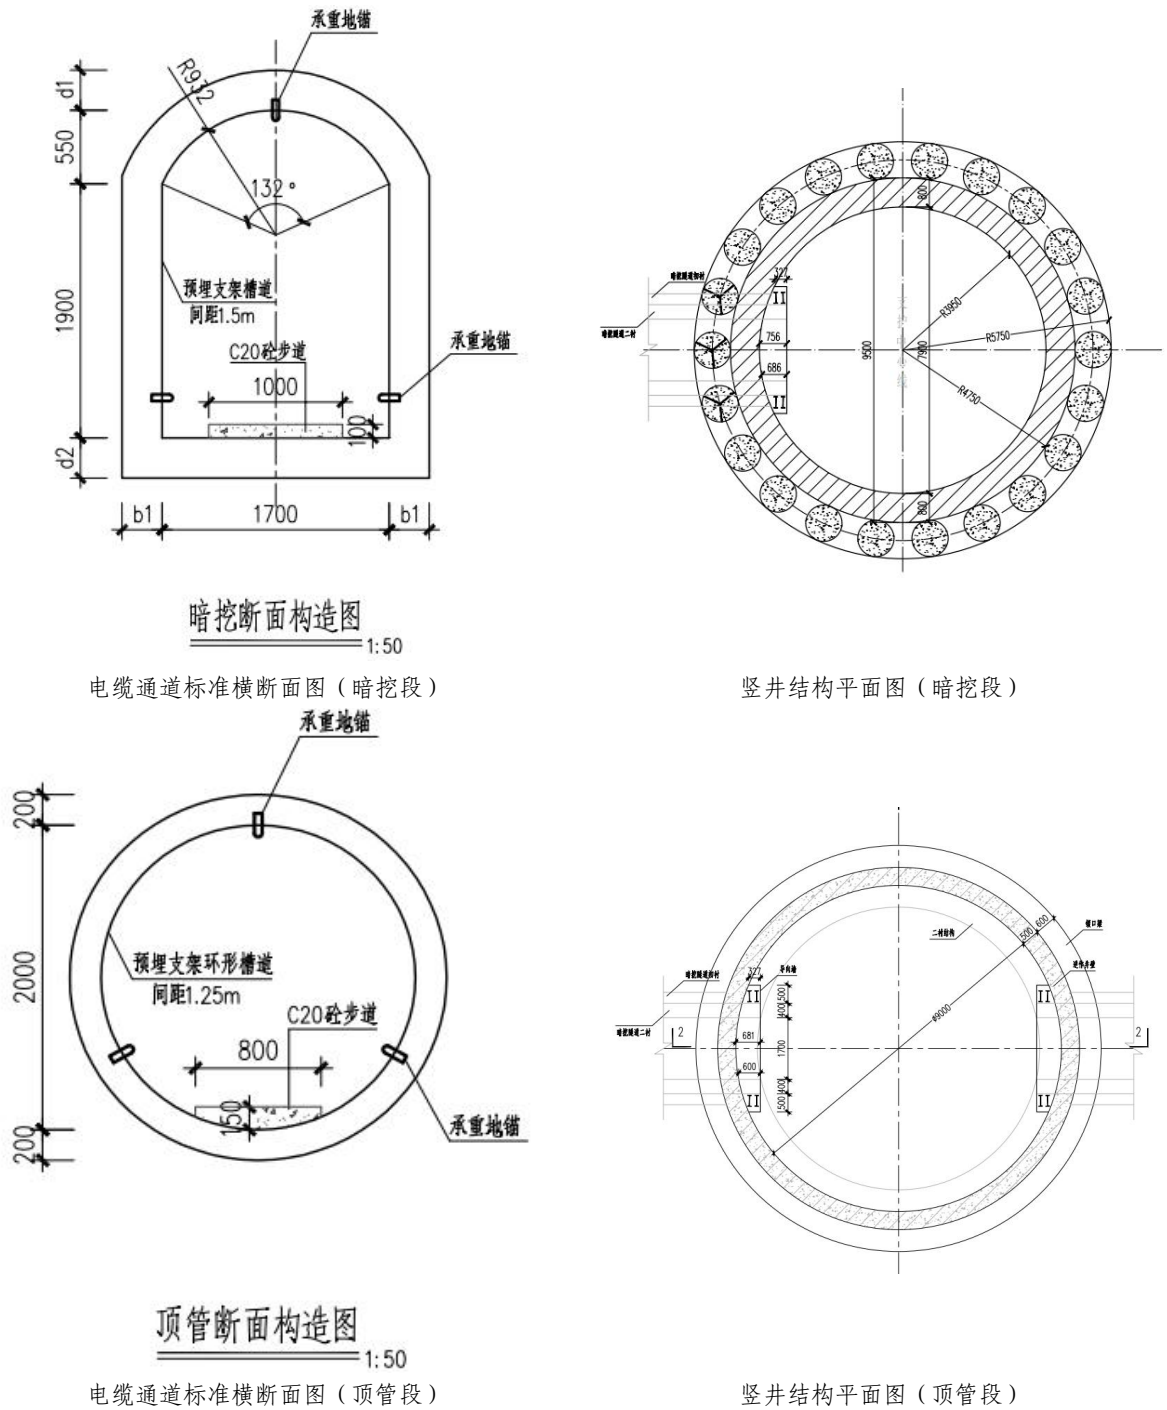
本工程新建电缆通道横断面图及竖井结构平面图
